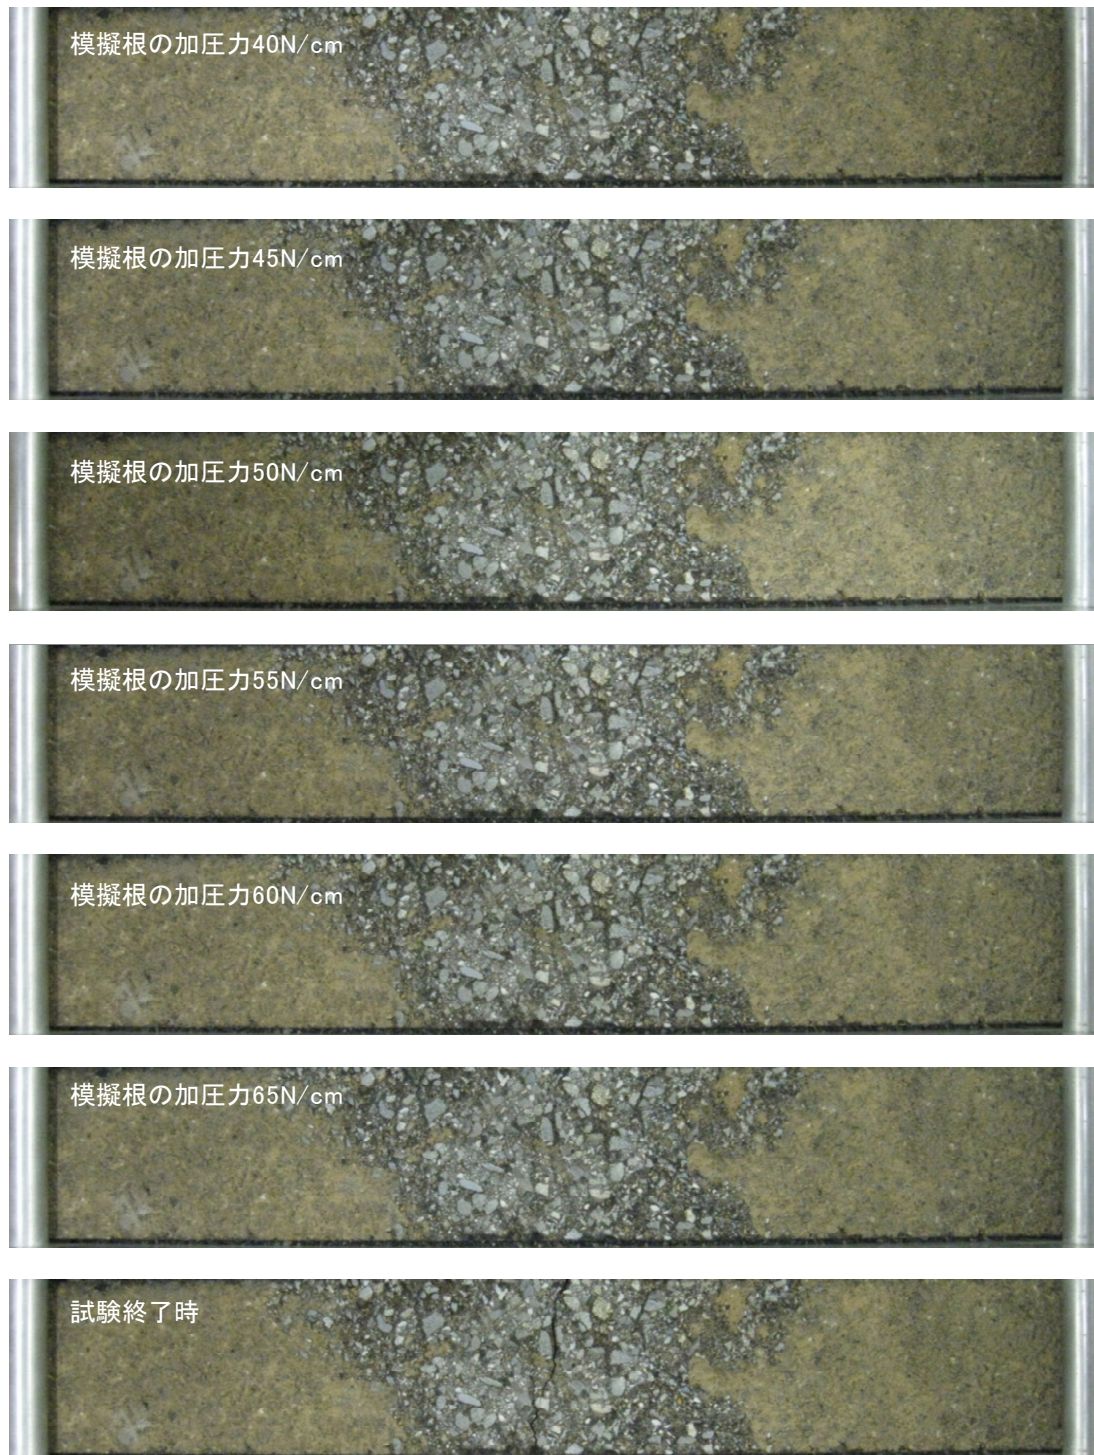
アスファルト舗装表面のひび割れ状態の一例(模擬根直上の砂層の厚さ10mm) 2/2
